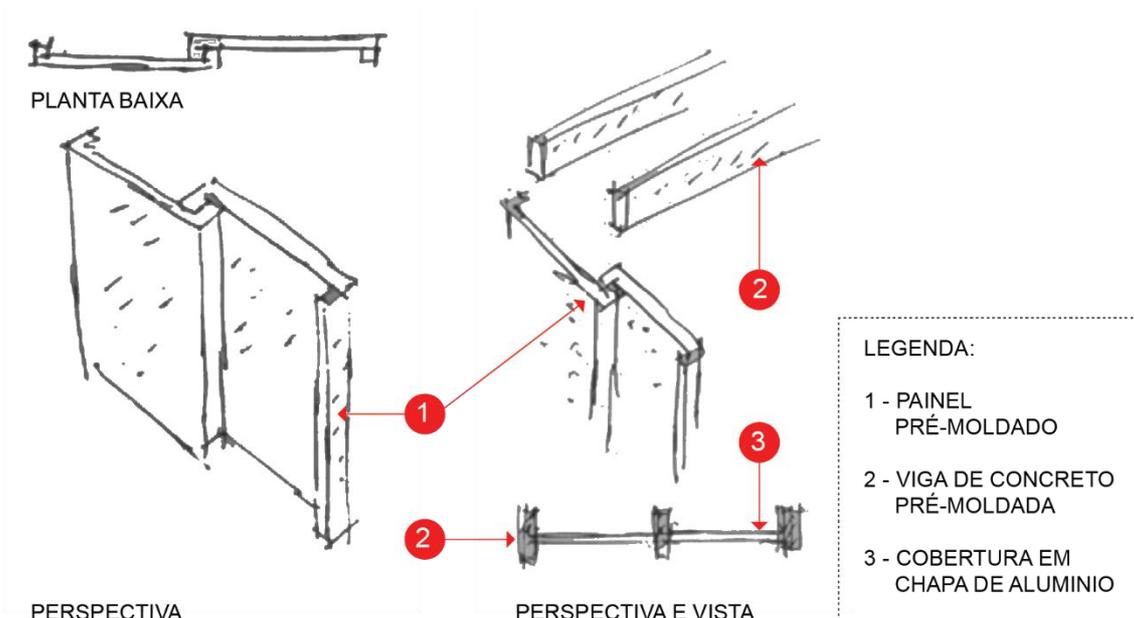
Croquis com peças do sistema estrutural do CEPLAN
